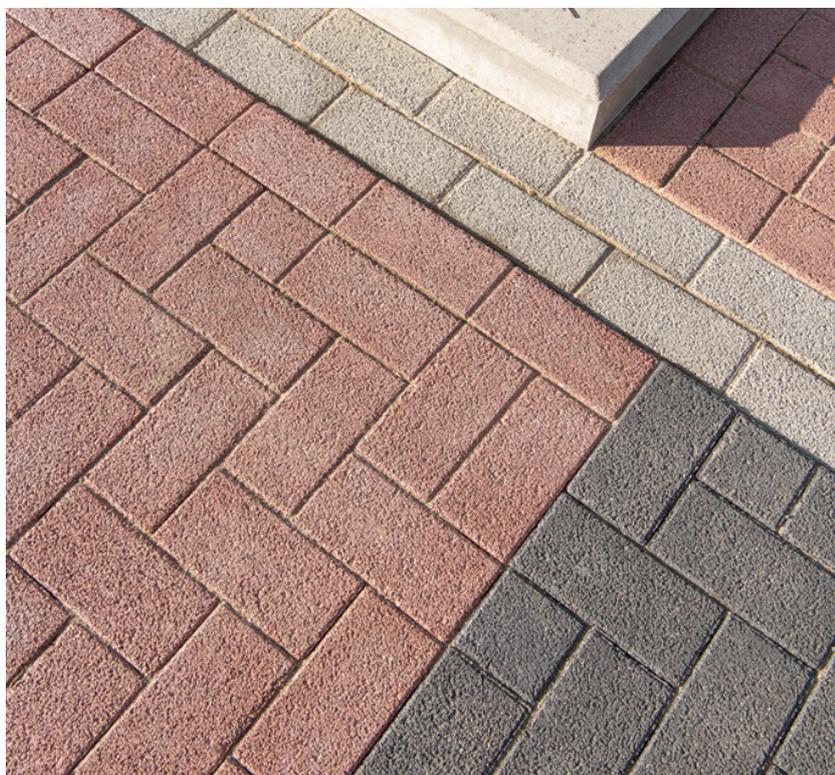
Pavés en béton poreux (Parking Brico Plan-it - Ternat) (Stradus, s.d.)
